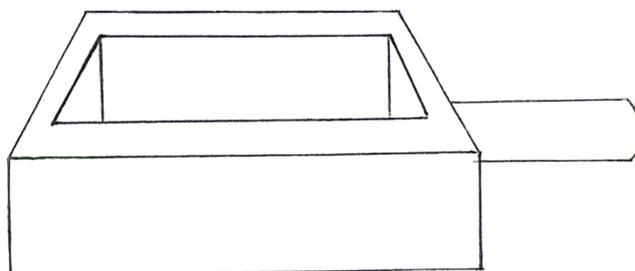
Adobe, molde em madeira para a execução do adobe ( desenho da autora)
